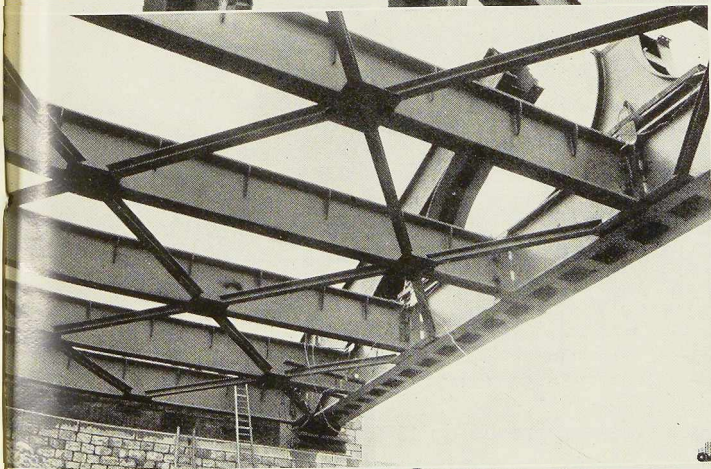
Détail du contreventement inférieur en treillis. On constatera qu'il y a des poutres transversales non seulement au droit des montants mais également au milieu des panneaux.
